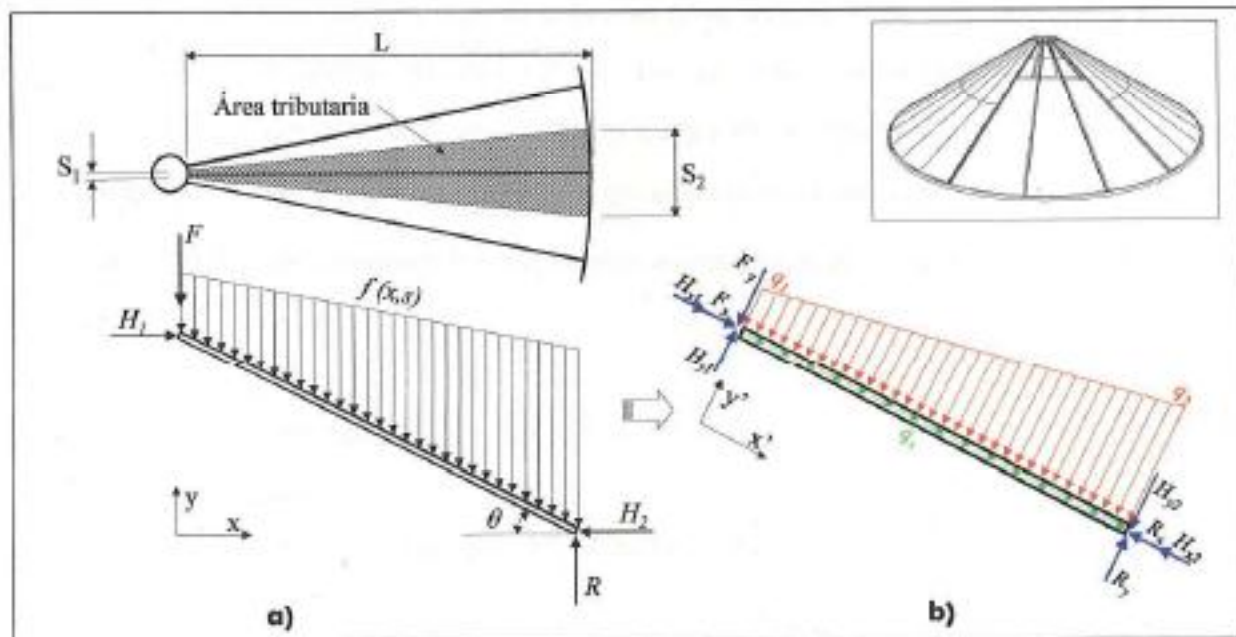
Viga principal de techo cónico. a) Área tributaria de la superficie del techo y cargas aplicadas sobre la viga principal; b) Diagrama de cuerpo libre para el diseño de la viga.
